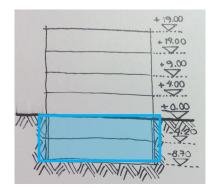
Área de sótanos en la que se encuentran las columnas de mayor sección 60x60 cm
